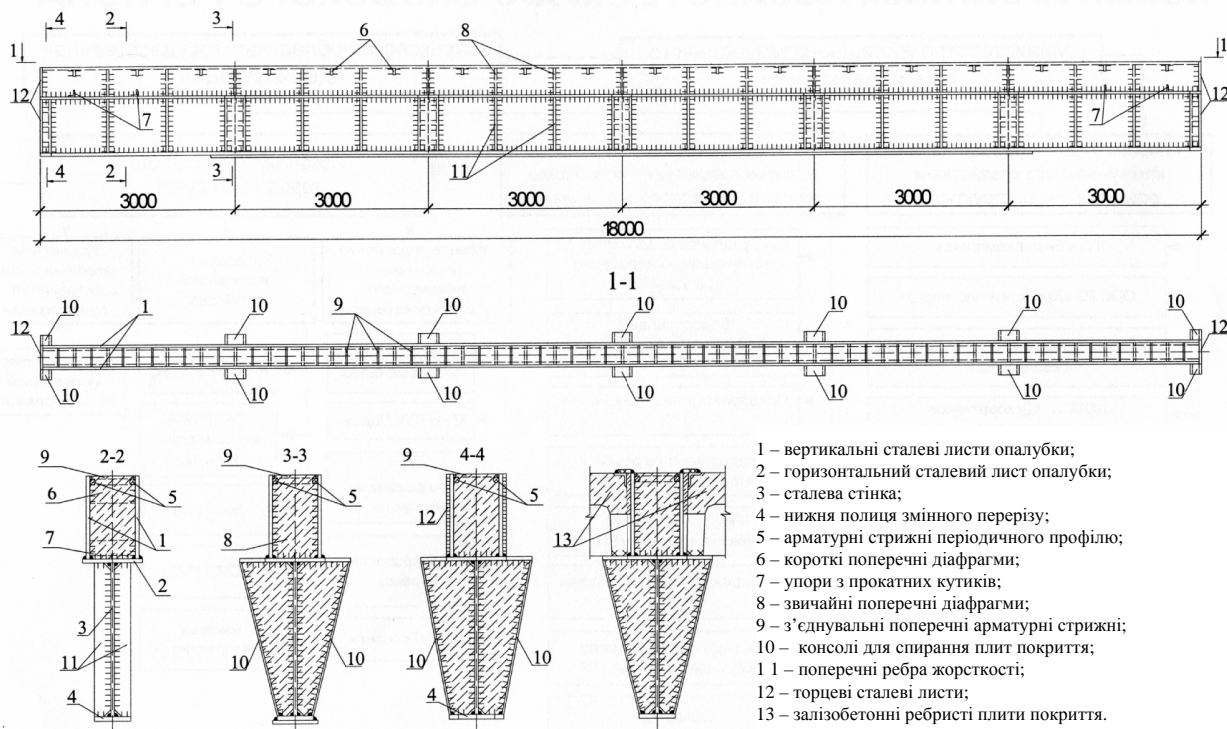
Конструкція сталезалізобетонного ригеля прольотом 18 м
